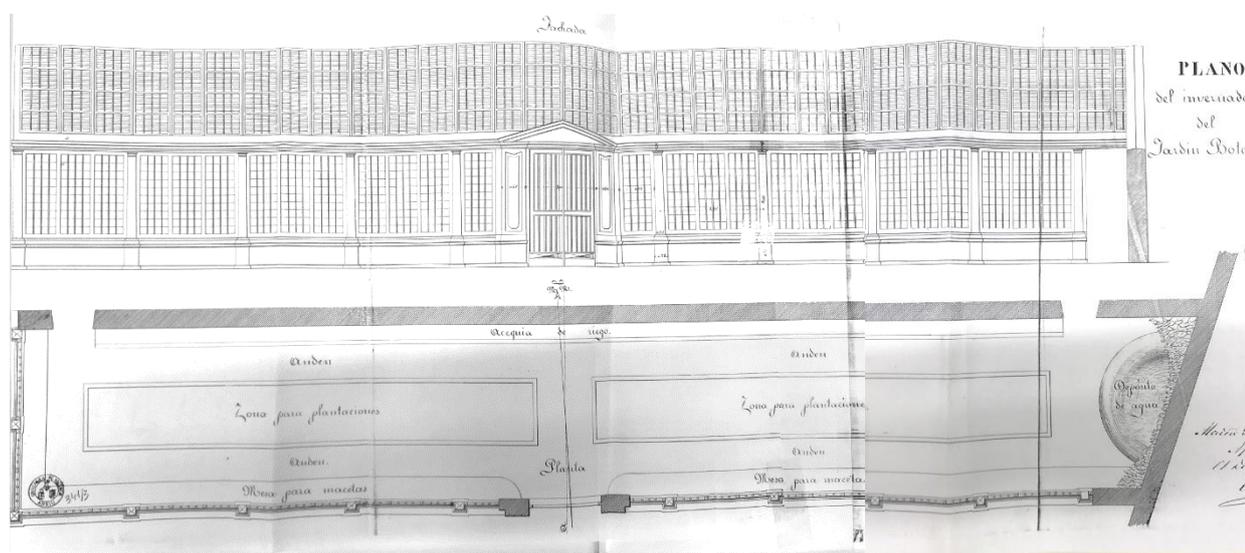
Proyecto para el Invernadero de la Balsa proyecto de Idelfonso Fernández, para sustituir el existente de madera de Timoteo Calvo. 1867, Alzado y planta.
